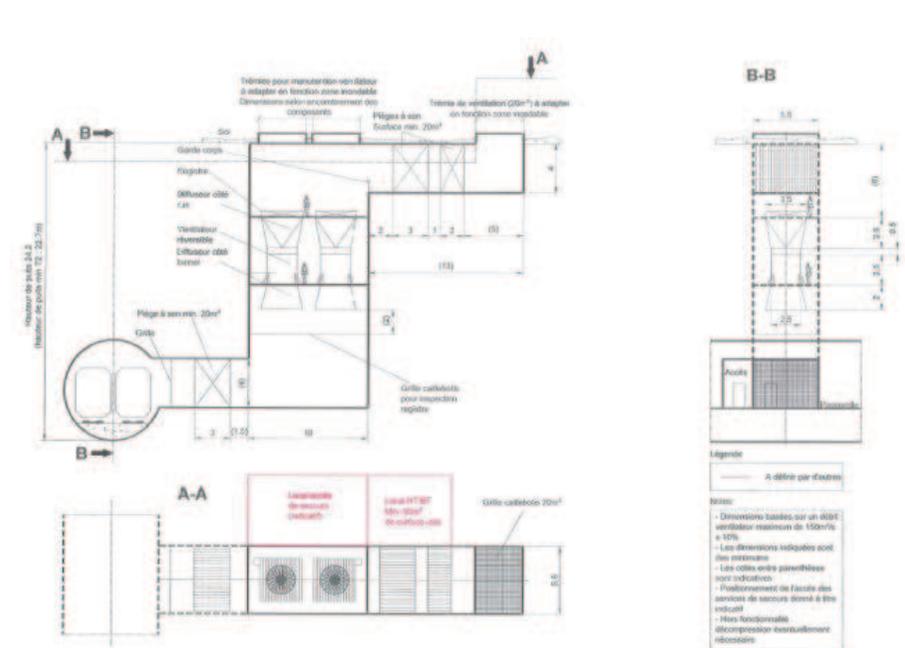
Plan type ouvrage annexe avec ventilateurs verticaux (Source : STIF)
